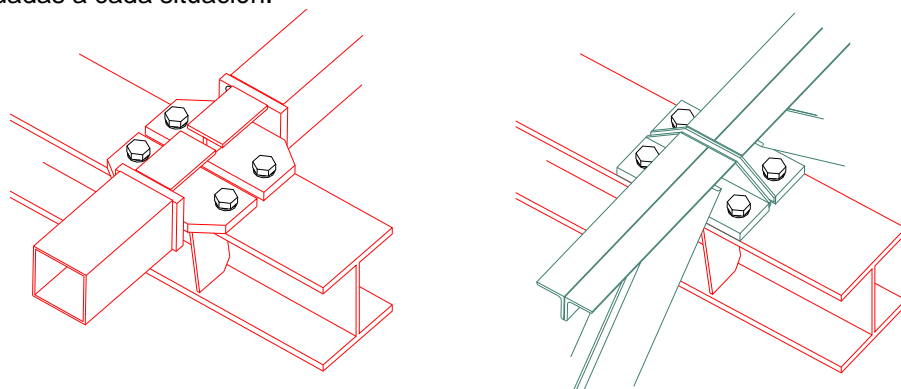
UNIONES SIMPLEMENTE APOYADAS
